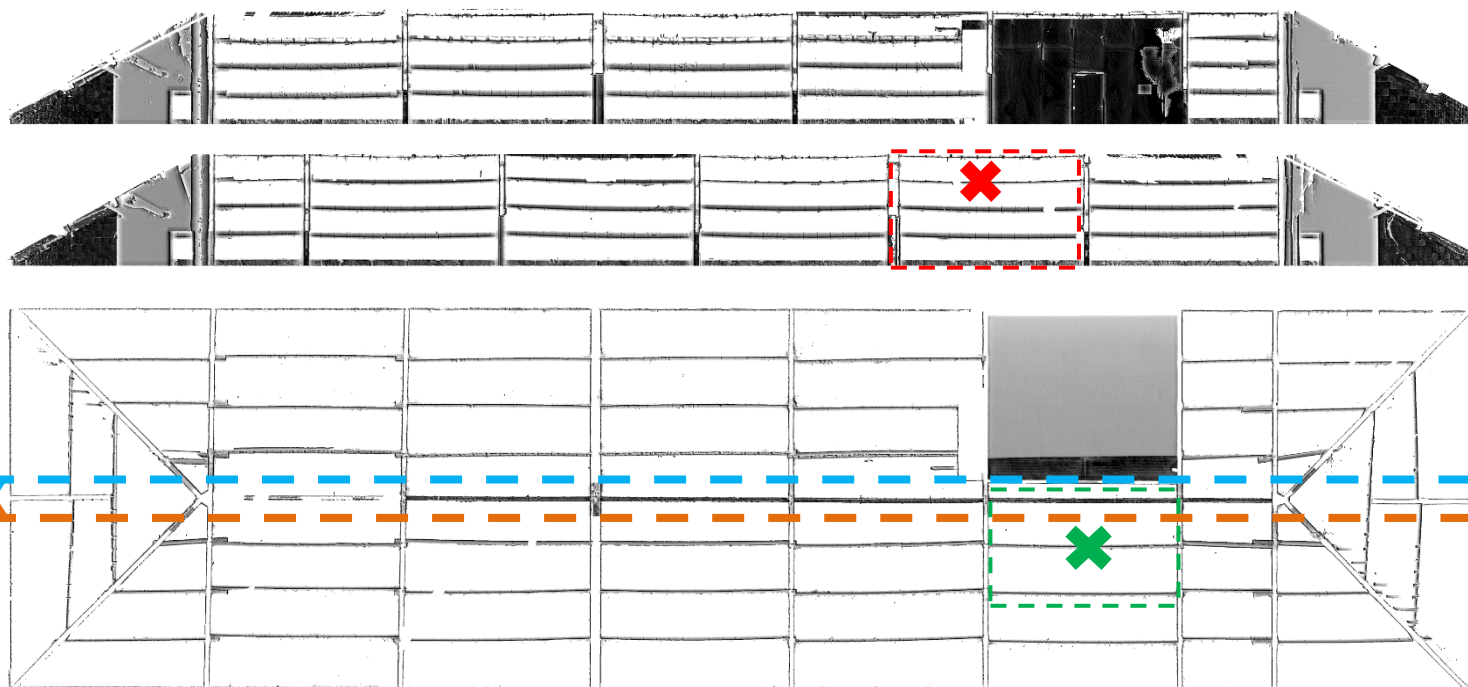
Bâtiment 6 - De haut en bas : Coupe AA', Coupe BB' et plan de charpente d'après les relevés lasergrammétriques
